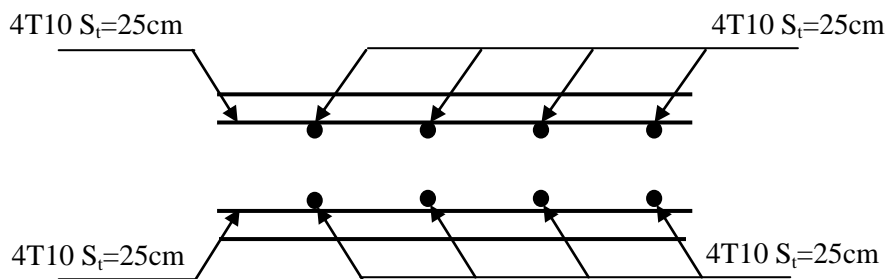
Vue en coupe du ferrailage de la dalle.
